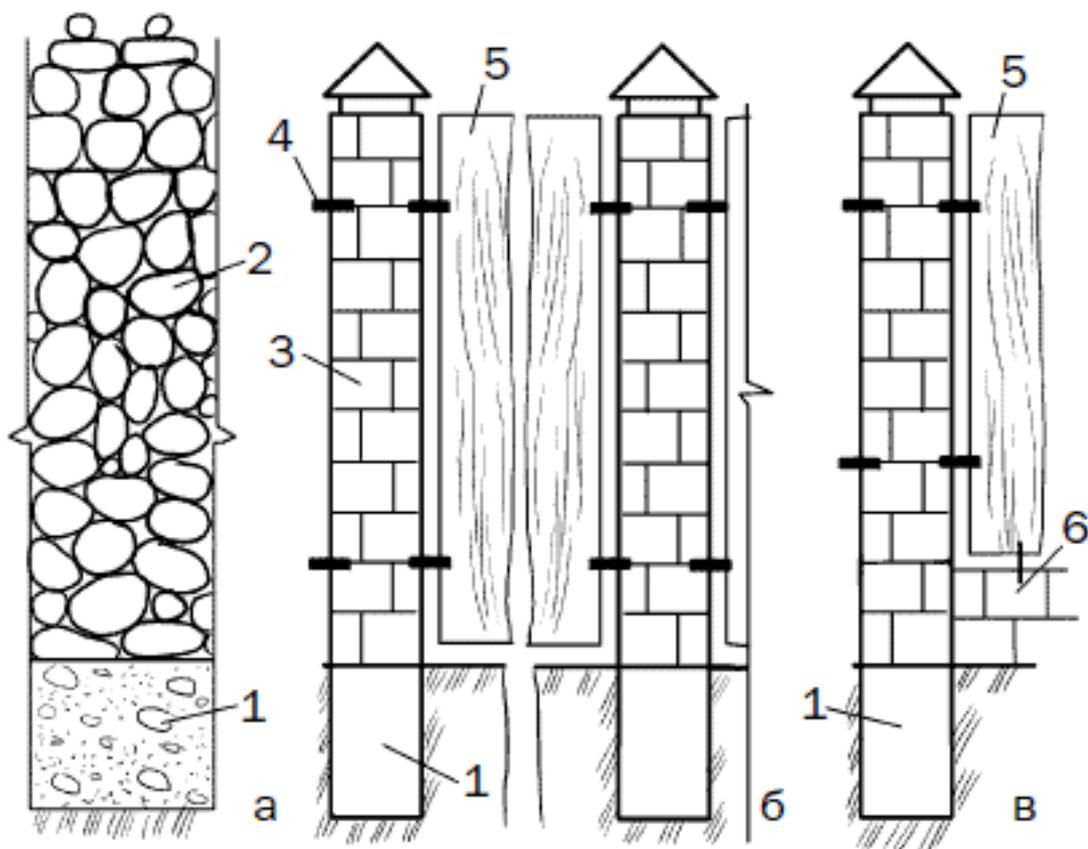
Возможные конструкции ограждения: а – сплошной бутобетонный забор; б – кирпичный каркас с рамами-конвертами; в – забор с кирпичным каркасом и забиркой; 1 – фундамент; 2 – кладка; 3 – столб каркаса; 4 – крепежный элемент; 5 – рама-конверт; 6 – забирка
